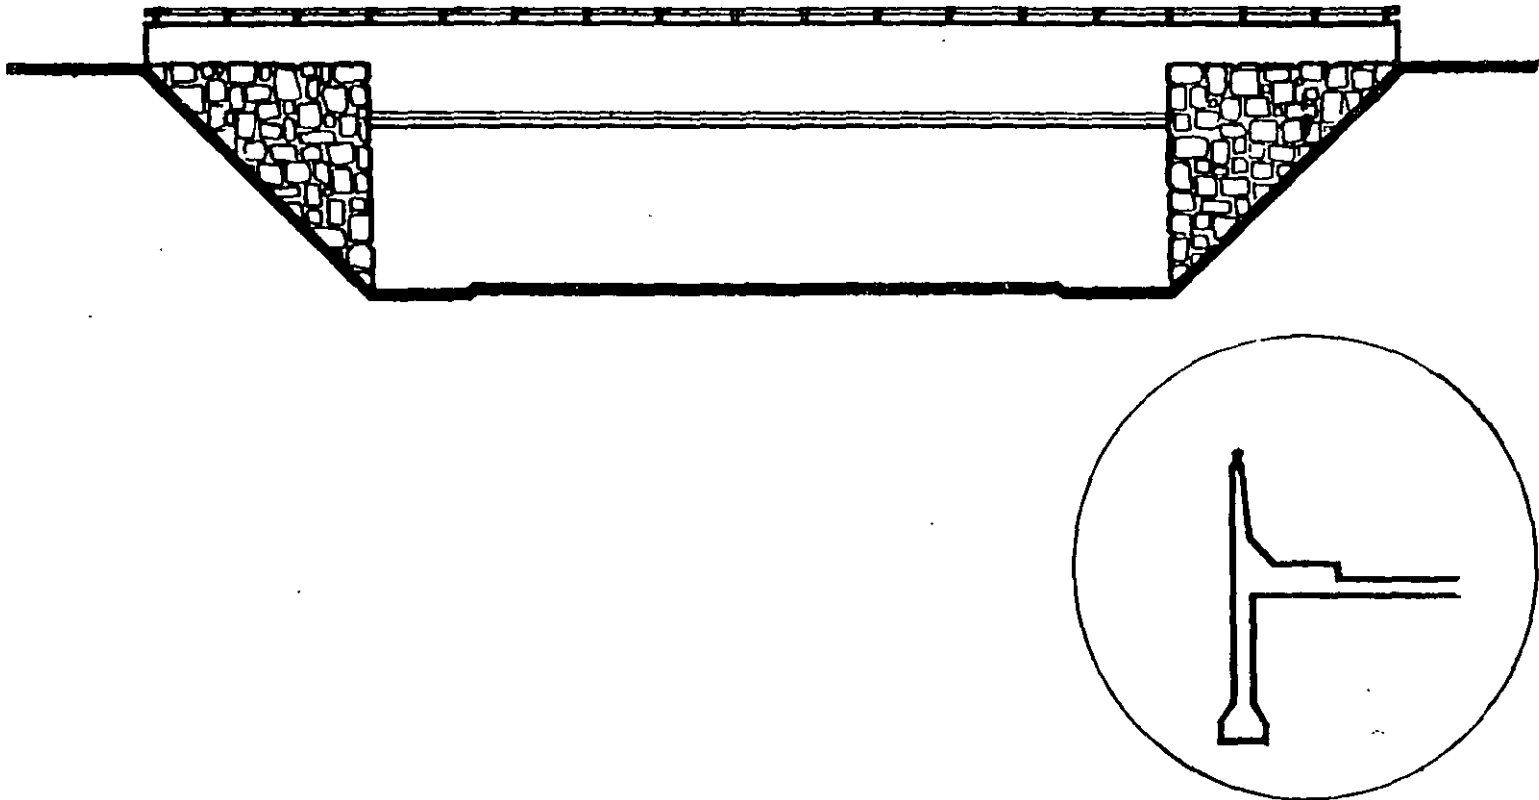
PARAPETO DE CONCRETO AL MISMO PAÑO QUE LA ESTRUCTURA
